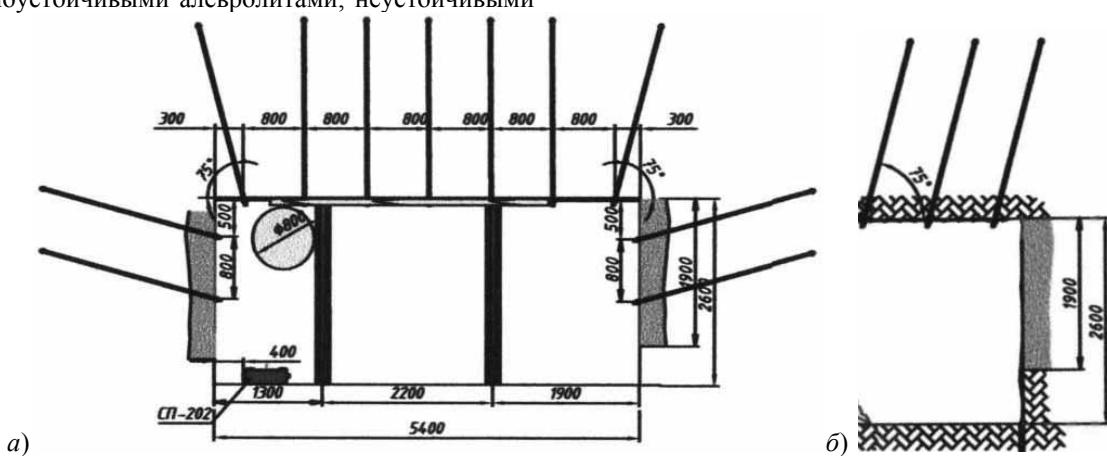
Схема установки анкерной крепи: а) поперечное сечение; б) продольное
